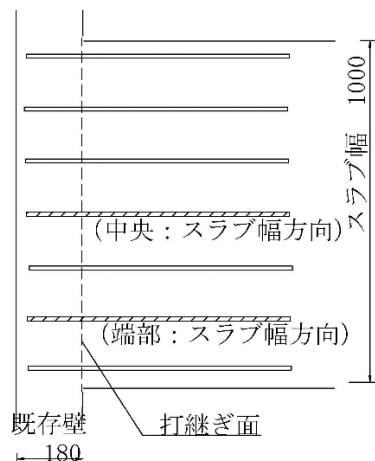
アンカー筋および定着筋のひずみ測定位置(平面図, 写真)
